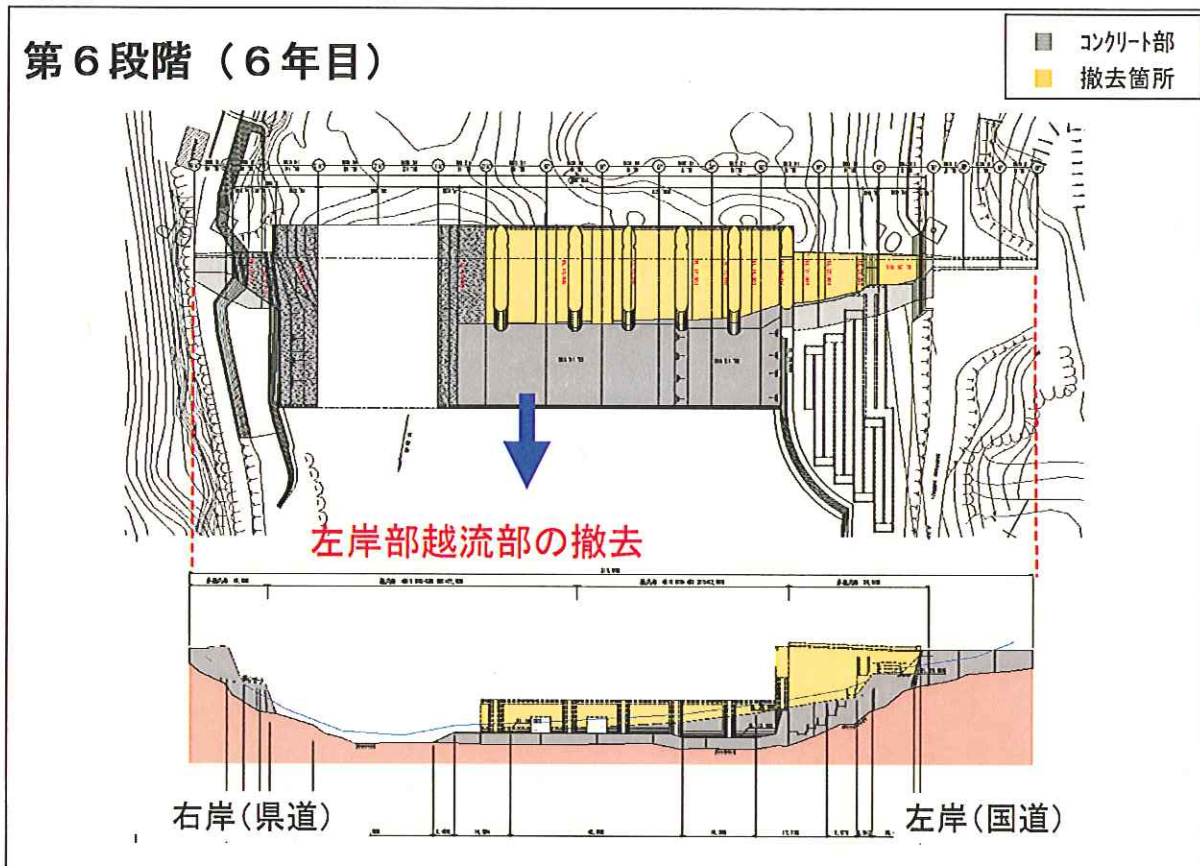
(4) 撤去計画平面図、下流面図 (第6段階、撤去完了)
